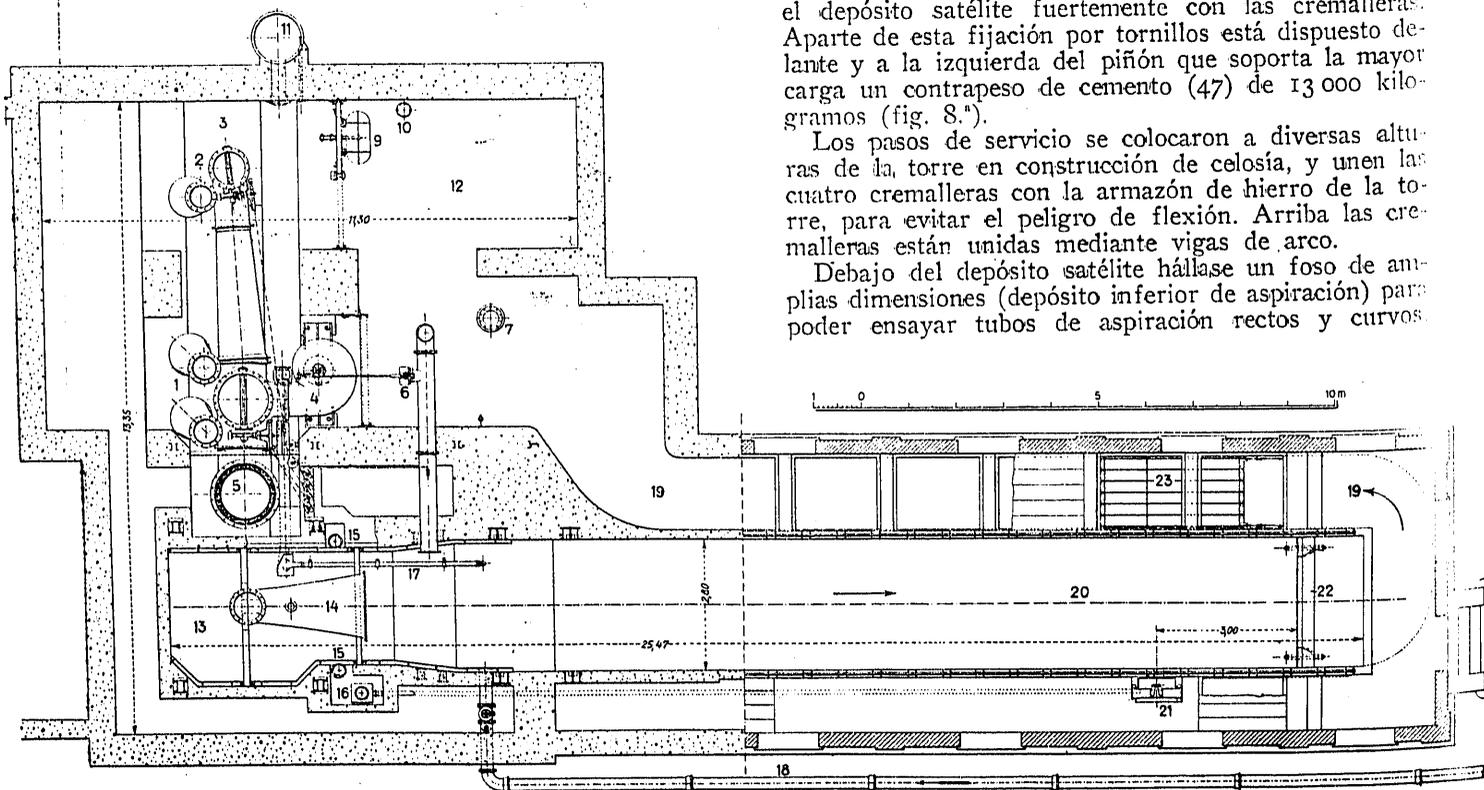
ª Planta de sótanos, a la izquierda, y planta baja, a la derecha. Corte horizontal de los canales. Escala, 1 : 160.
